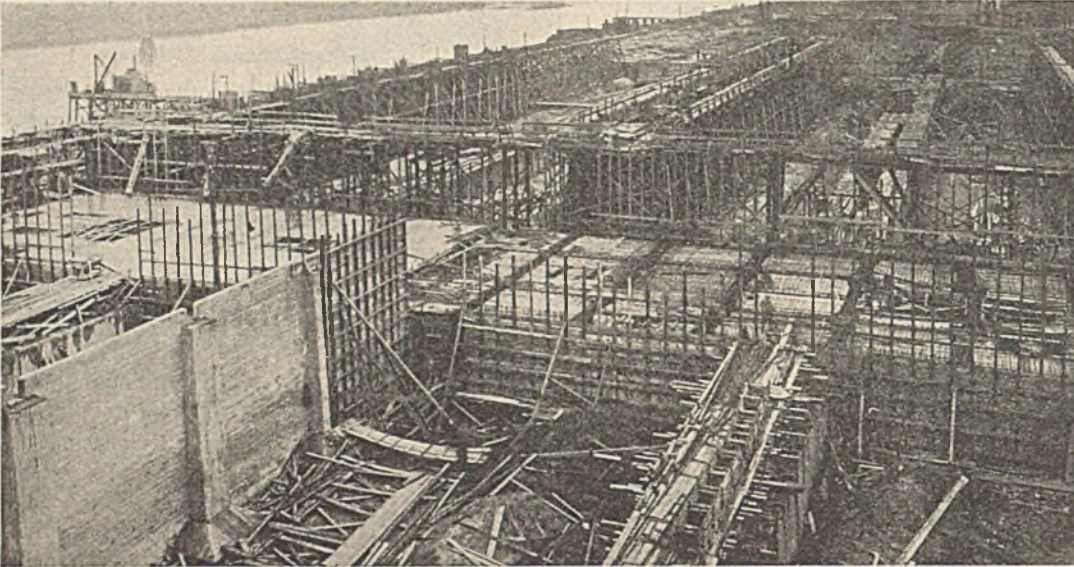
Betonarbeiten an Schuppenwänden und Kellerdecke der Verladestation West.
